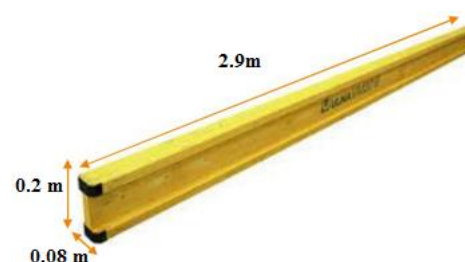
POUTRELLE UTILISEE EN COFFRAGE
